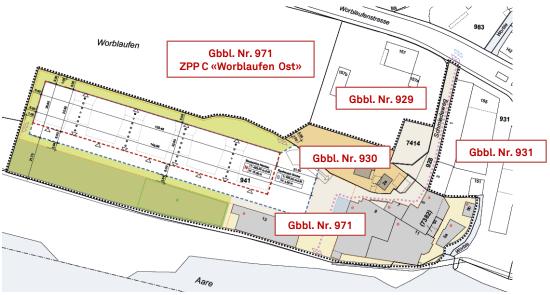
USP B «Hammerwerke» - Zur Orientierung
